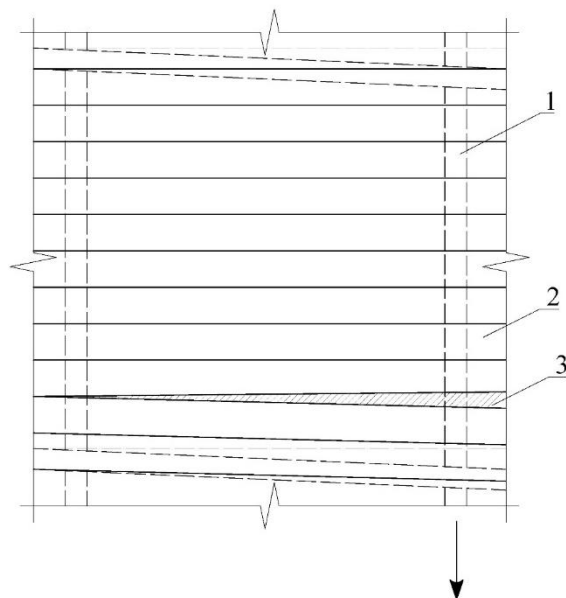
Принципиальная схема дефекта - осадка элементов каркасных стен деревянного здания с образованием перекосов и щелей: 1 – стойка каркаса; 2 – элемент обшивки стены (доска); 3 – щель между элементами обшивки стены; b – ширина щели между элементами стены, см.
